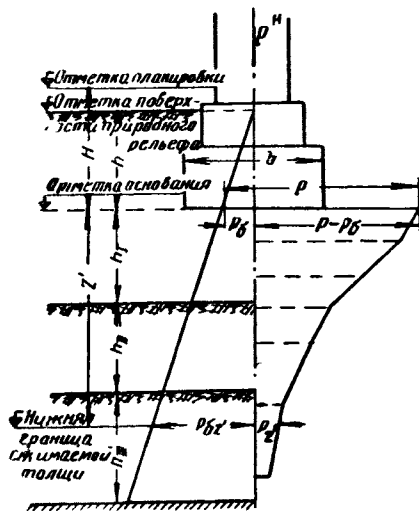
(1). Расчетная схема распределения давления на горизонтальных сечениях в грунте ниже подошвы фундамента
